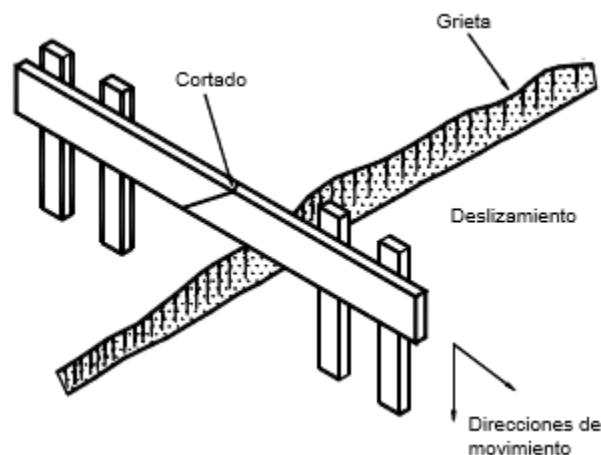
Esquema de extensómetro horizontal. (Fuente: Suarez, J. 2009)
